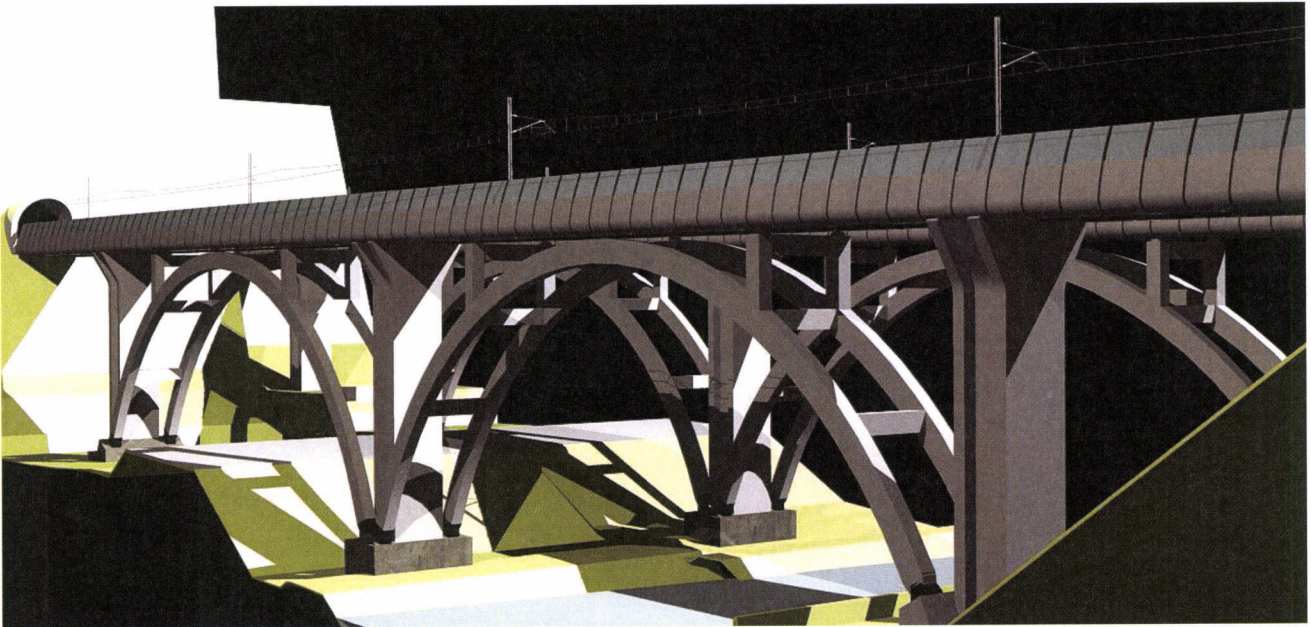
Soluzione prevista nell'attuale livello di progettazione
